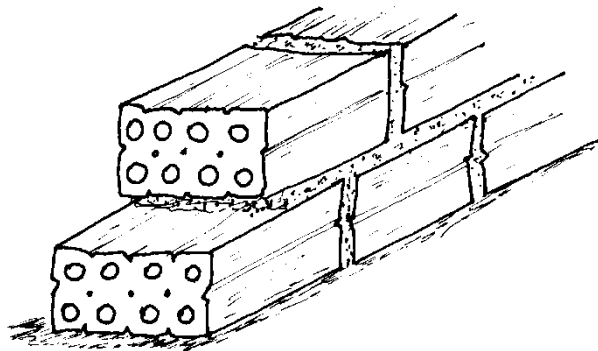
Execução de alvenaria de 1 vez, utilizando tijolos furados.
